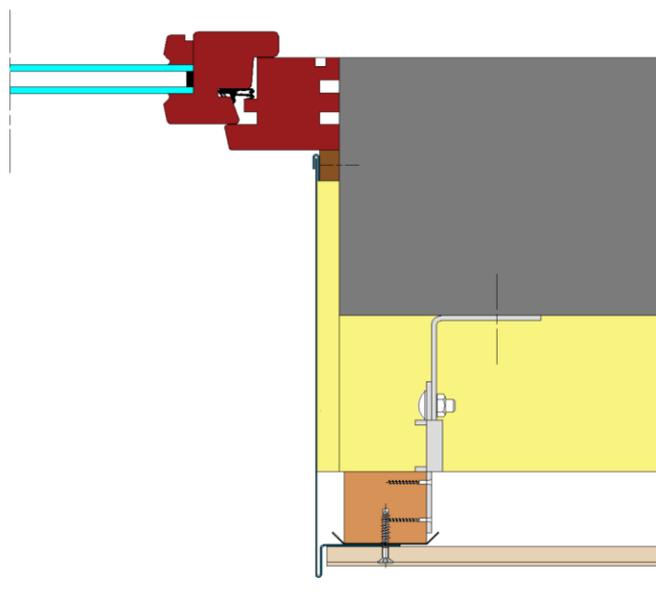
Encadrement de fenêtre coupe sur tableau – pose horizontale des lames CEDRAL LAP
